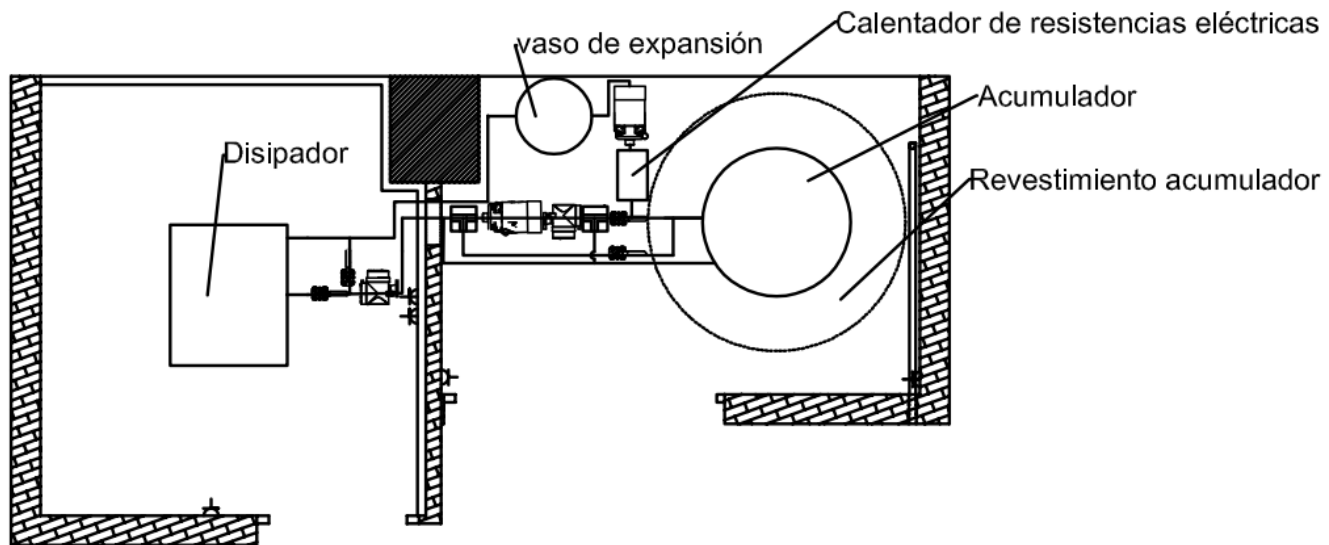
Distribución en planta de la instalación. Fuente: propia. Realizado en Autocad
